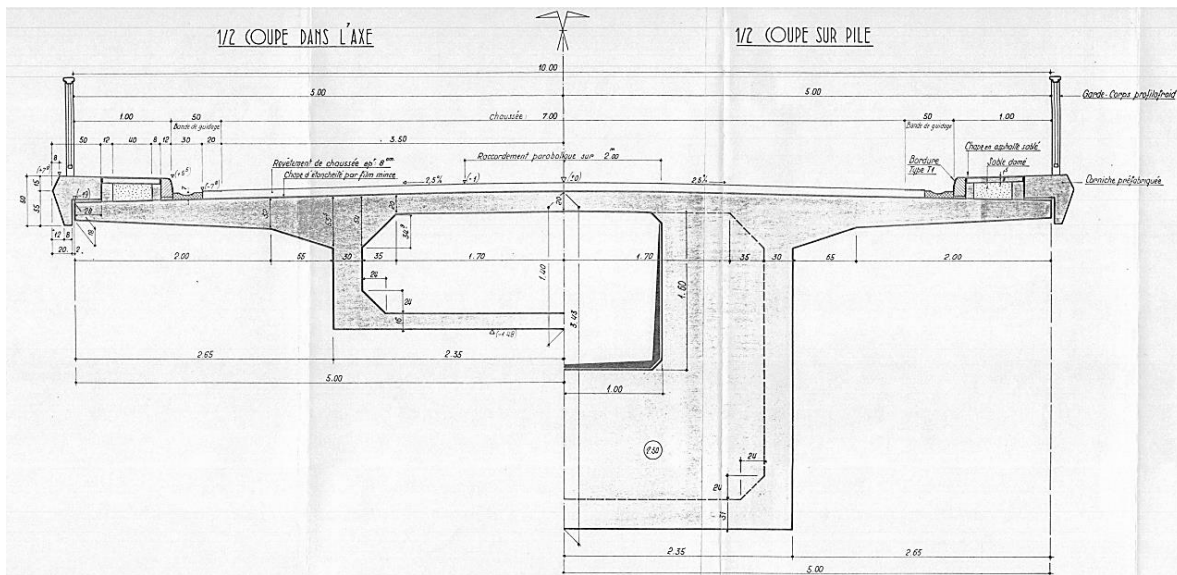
Coupe longitudinale et coupe transversale dans l'ouvrage (documents d'archive)
